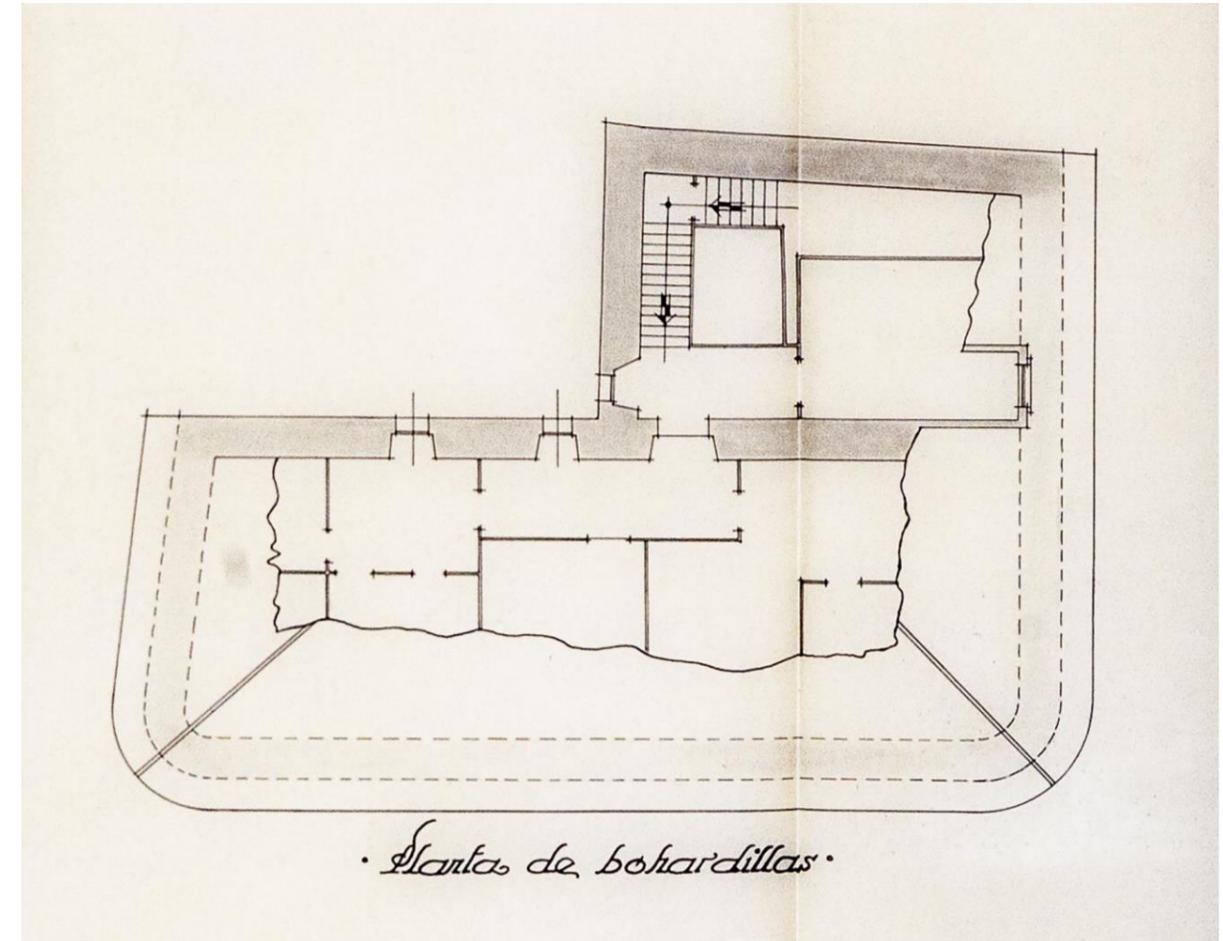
Planta de buhardillas de la Casa Cornide. 1951, Peregrín Estellés. AMC. Fondo Tenreiro, caja 26 (1). Foto José Caruncho
